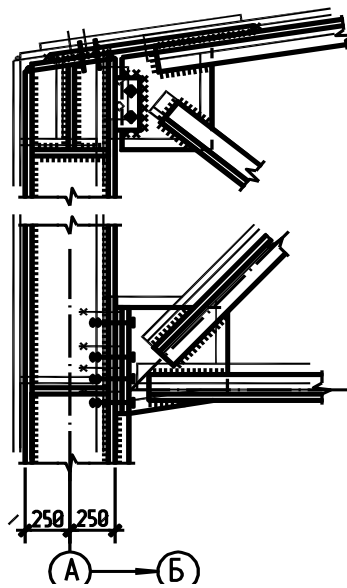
Узел сопряжения фермы с колонной
